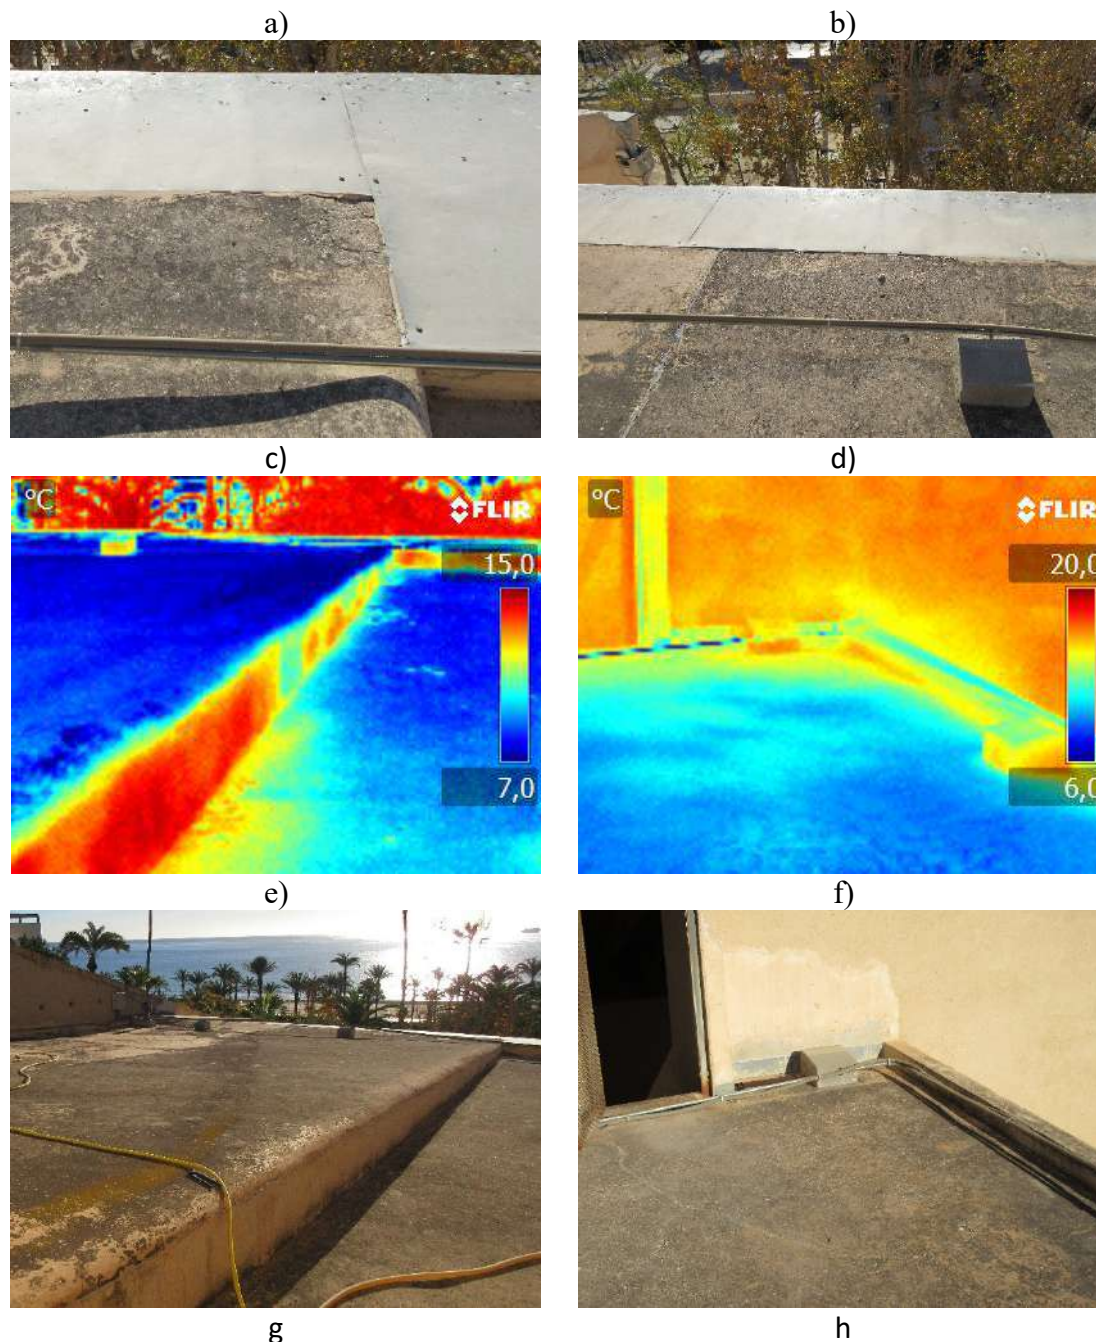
Termografía cubierta 2: a) Deterioro o inexistencia de junta perimetral, y detalle de conexión con albardilla metálica defectuosa, b) Detalle de fallo de la junta perimetral en zona de contacto del faldón con la fachada exterior, c) Imagen a) con cámara digital; d) Imagen b) con cámara digital; e) Detalle del extremo lateral del faldón y de la conexión con el resto de cubierta, filtración por juntas de mampostería, f) Zona perimetral del faldón en zona próxima a la puerta de acceso a la cubierta; g) Imagen e) con cámara digital; h) Imagen f) con cámara digital.
